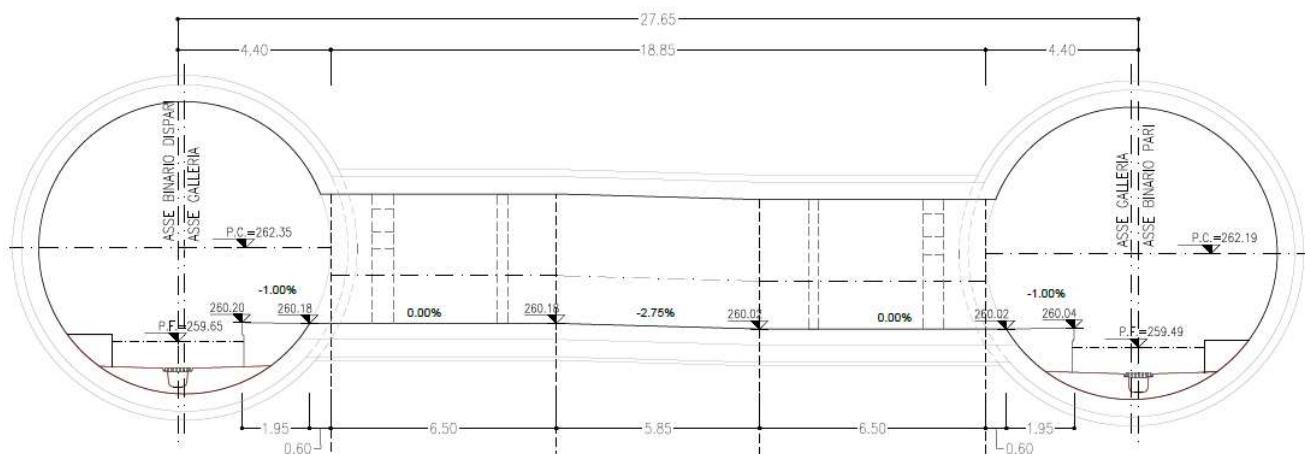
Bypass esodo tipo – Profilo longitudinale
